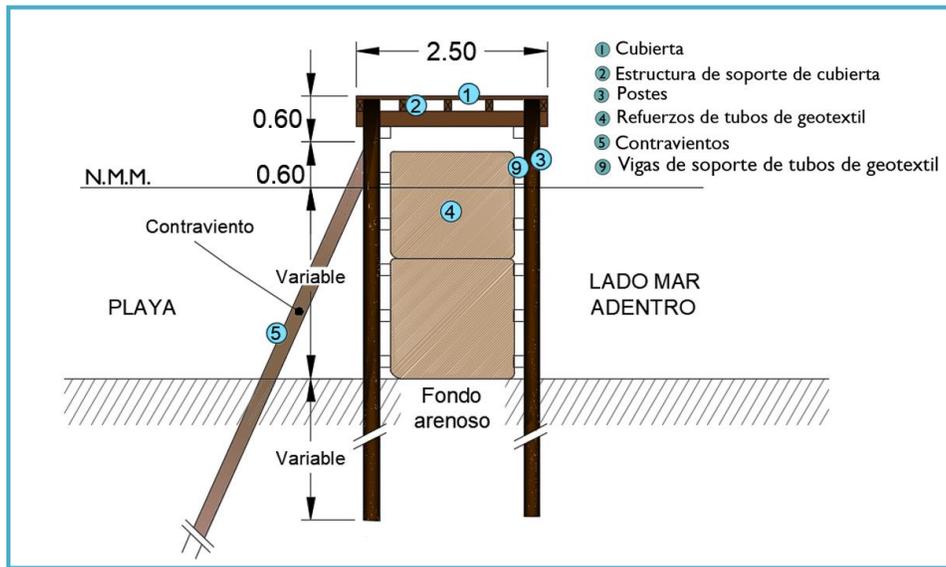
Sección de muelle con refuerzo de tubos de geotextil rellenos con arena.
